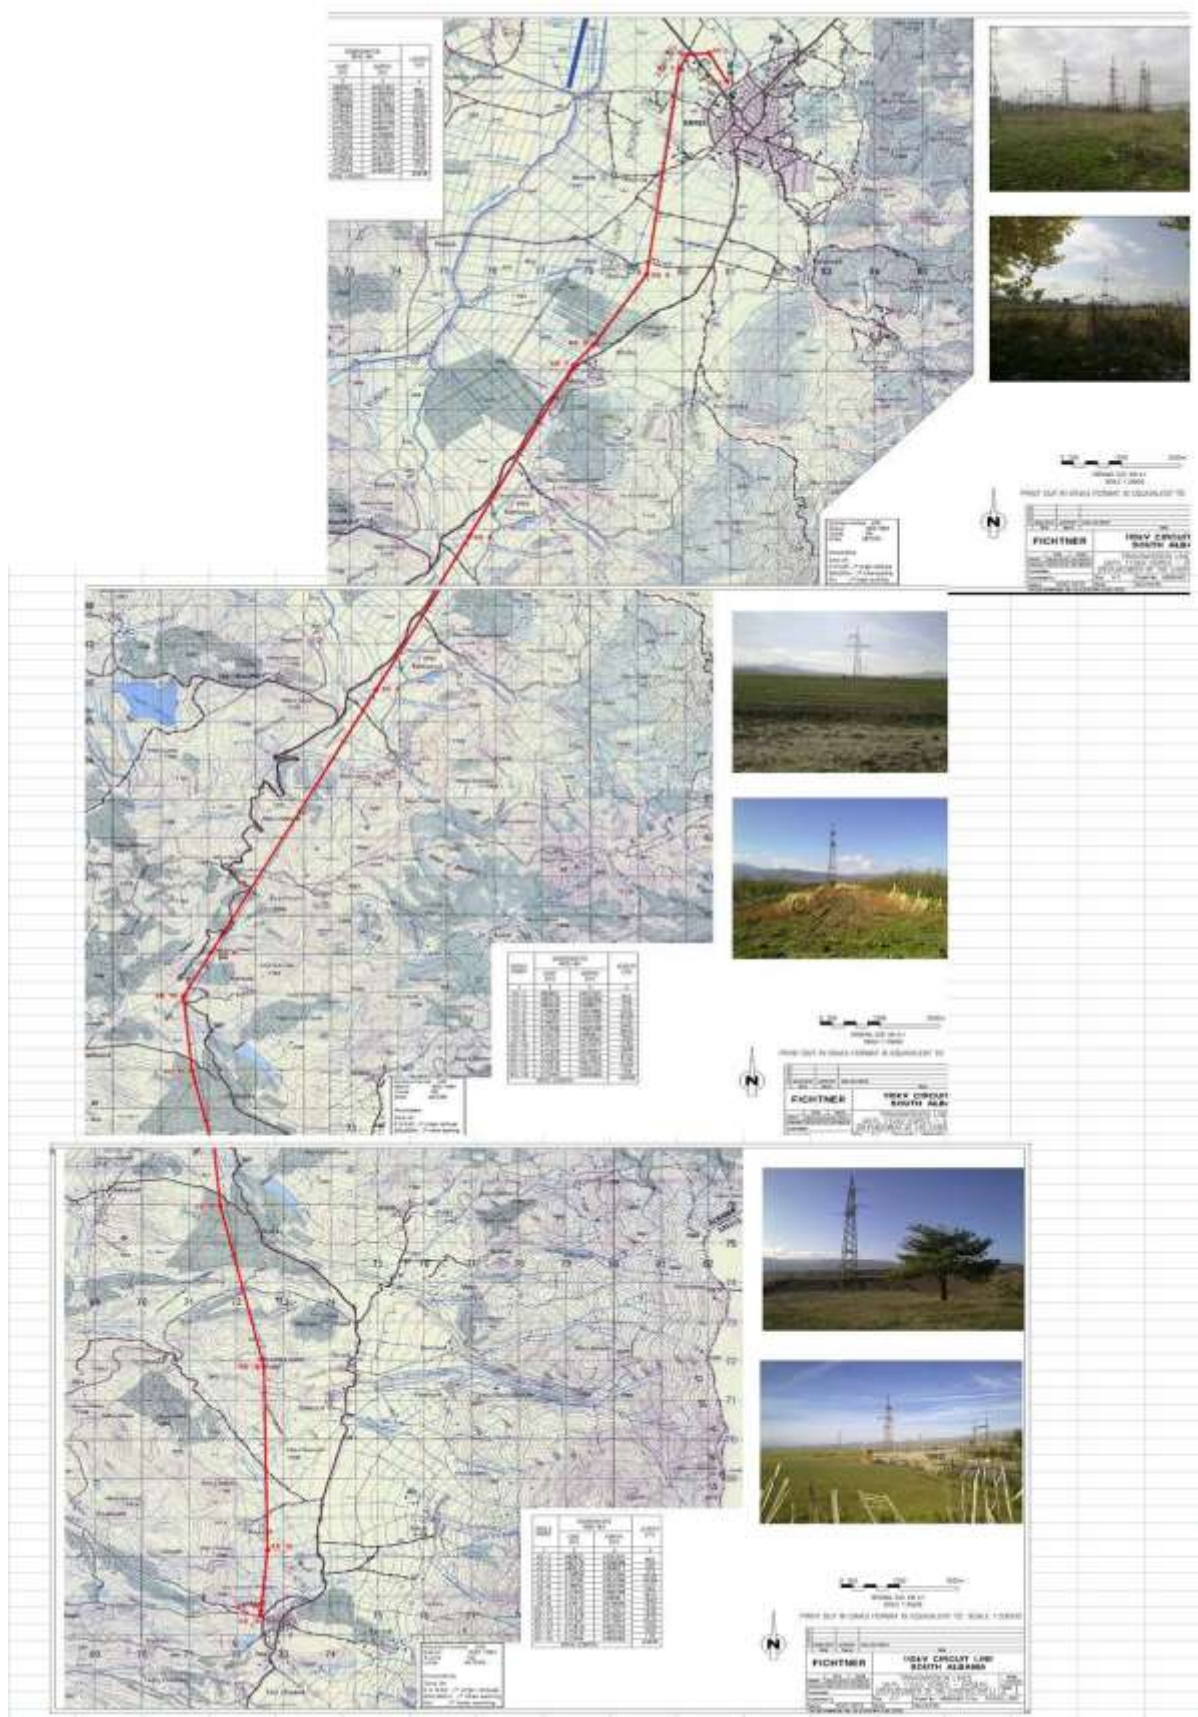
/2.: Planimetria e korridorit se linjes 110 kV Erseke-Korce
